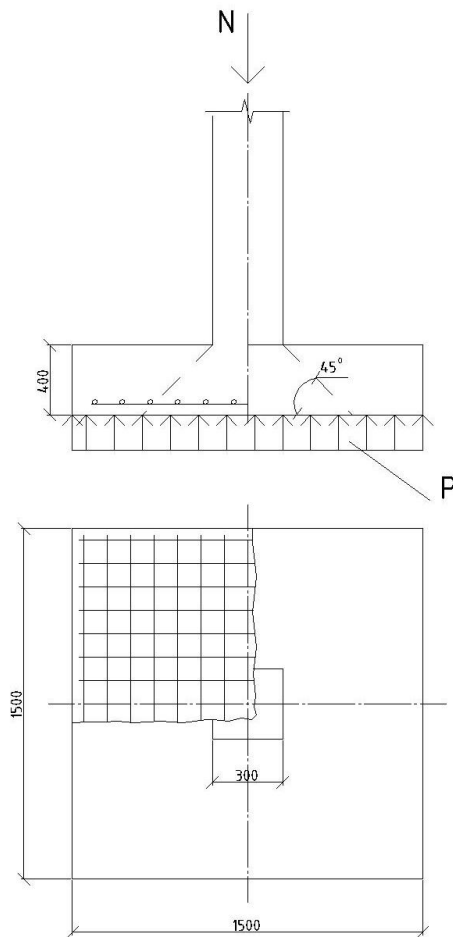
Расчетная схема фундамента на продавливание
